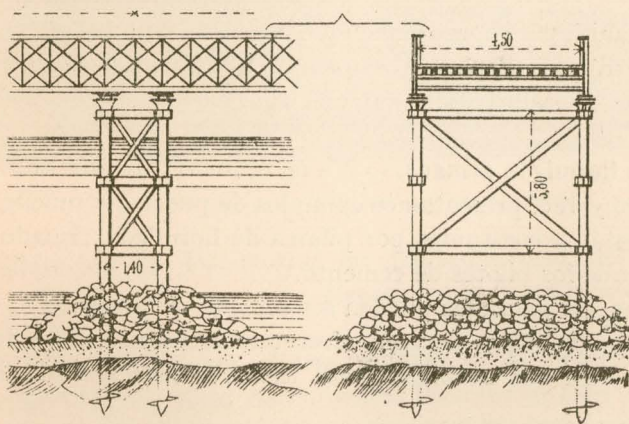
Puente sobre el río de las Piedras (Huelva).
